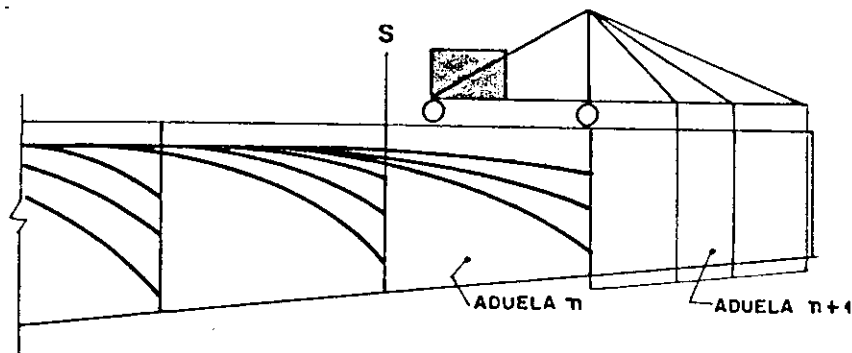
SITUAÇÃO DE CARREGAMENTO PARA A ANÁLISE DA SEÇÃO S
